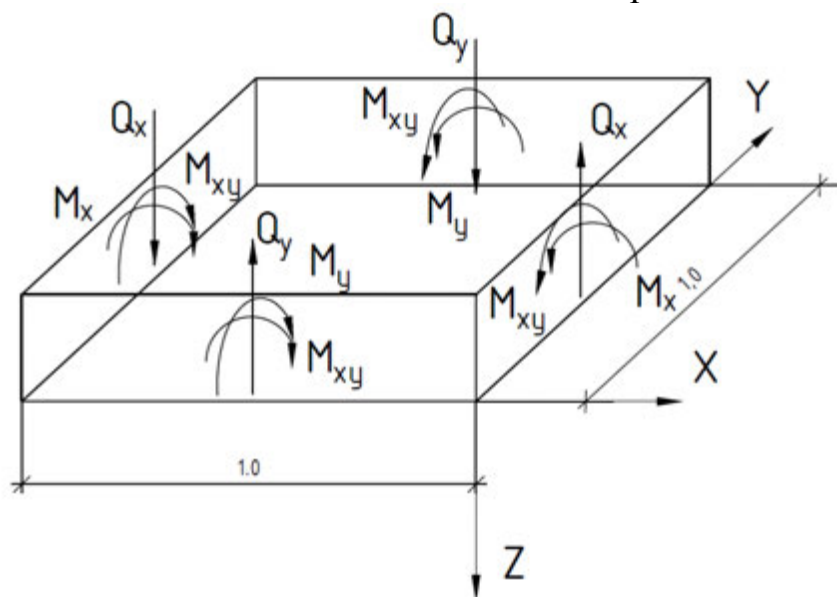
Схема зусиль, що діють в бетонному і арматурному шарях виділеного плоского елемента плити
